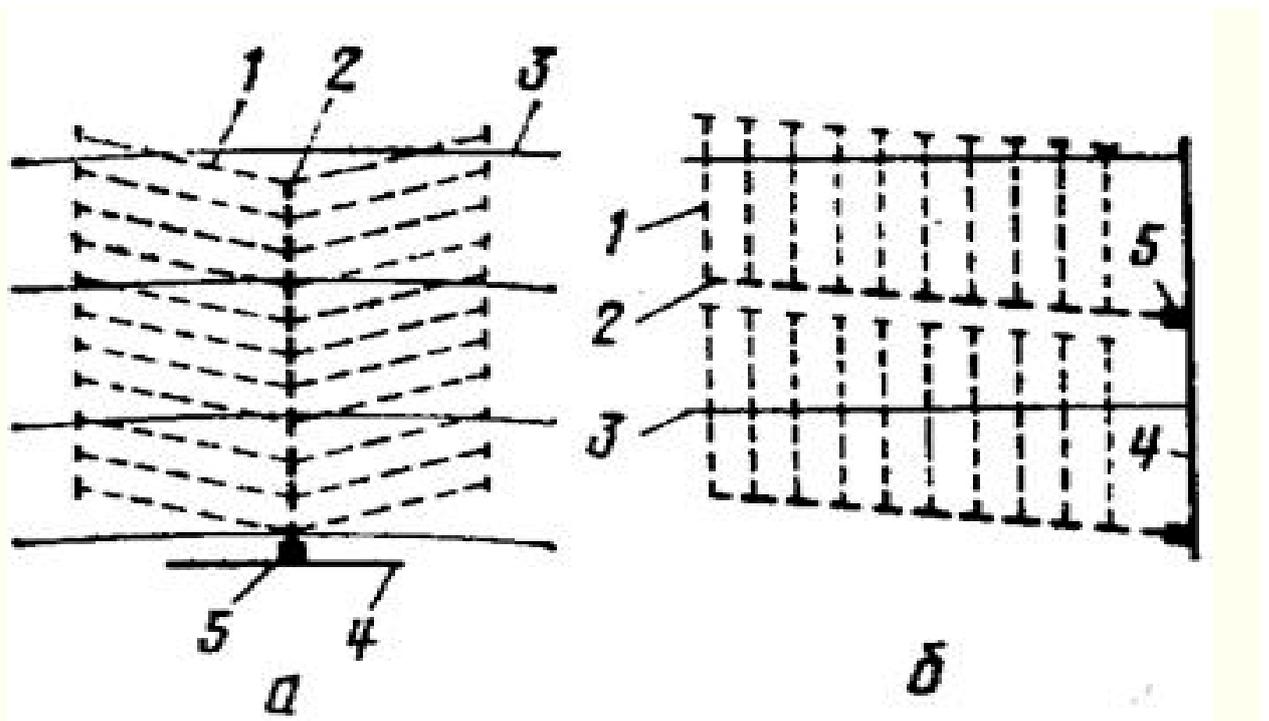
Поперечная (а) и продольная (б) схемы расположения дренажа:
